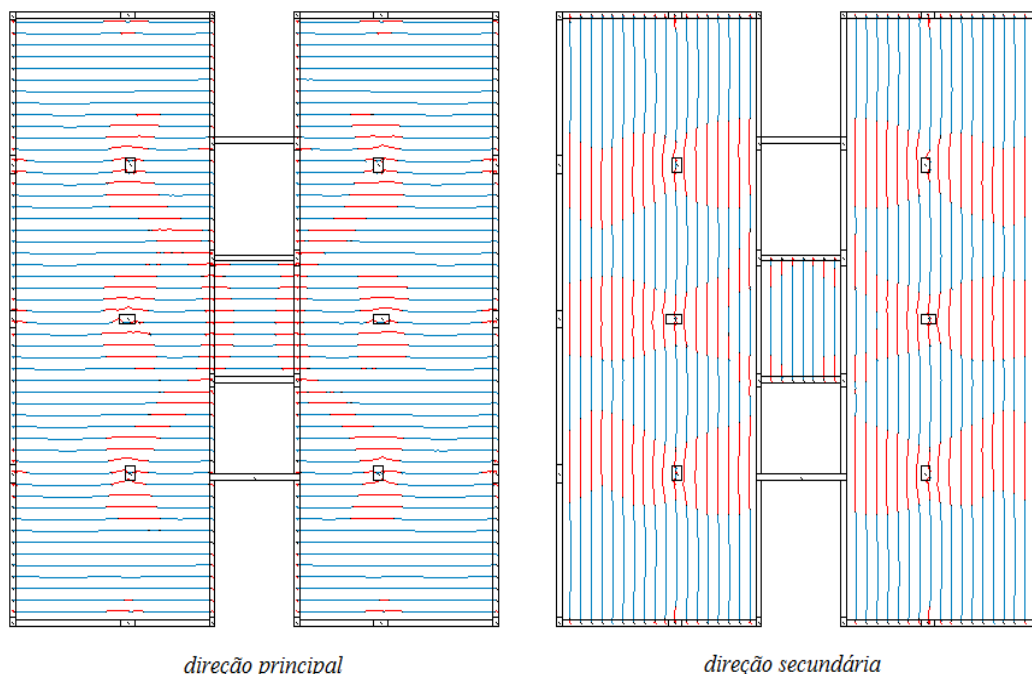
Distribuição de Momento Positivo e Negativos da Laje – Estrutura de Laje Lisa - Fonte: Adaptado do CAD/TQS (2016).
